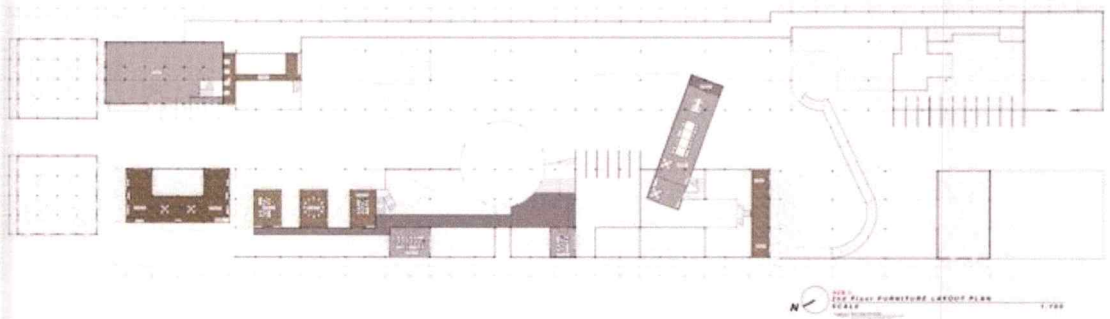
ผังอาคารโครงการ (Layout)
